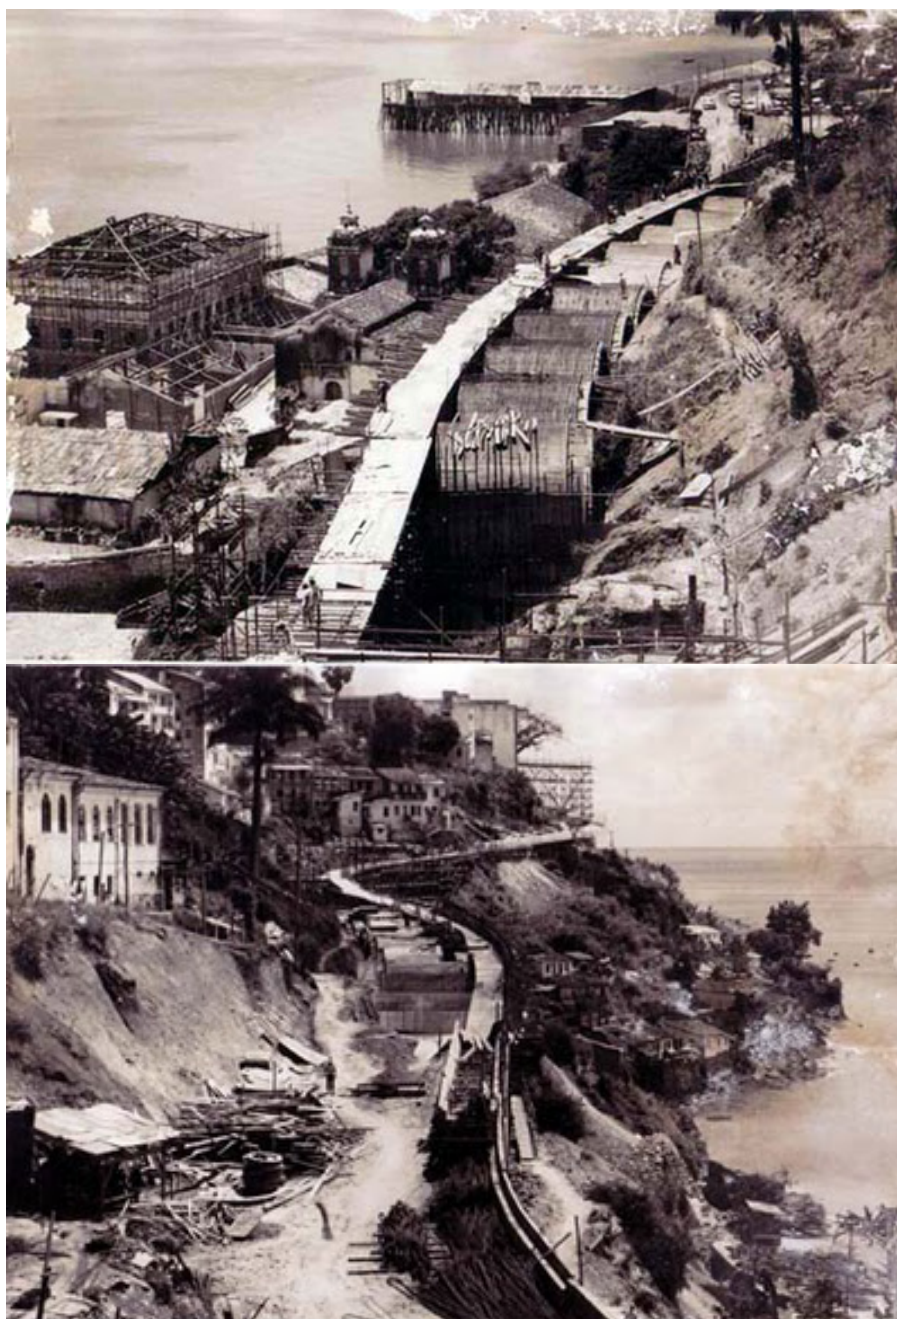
Construção da Avenida Contorno em Salvador, Bahia, durante a década de 60⁷².
